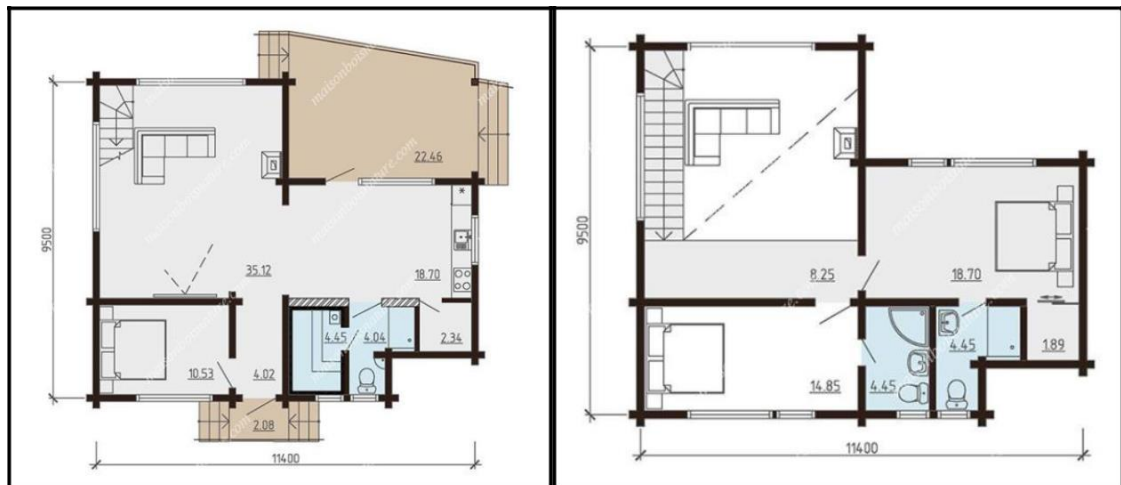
Plan de rez-de-chaussée +1er étage de Chalet de surface environ 131.79m²
